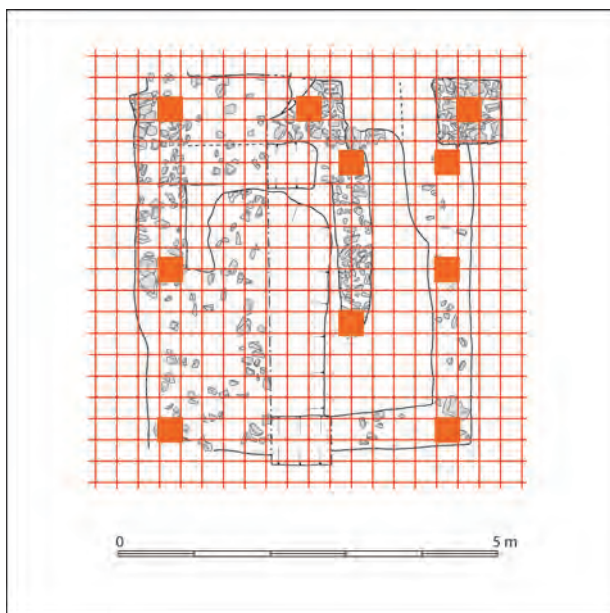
Hypothèse d'utilisation d'une grille de référence pour la conception d'une petite construction sur le site de La Touche Nicou à Betton (35).
